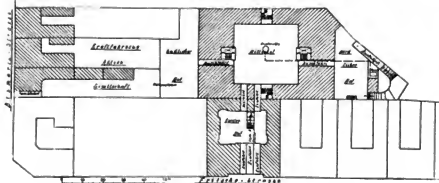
Lageplan der Garage der Kraftfahrzeug-A.G.
